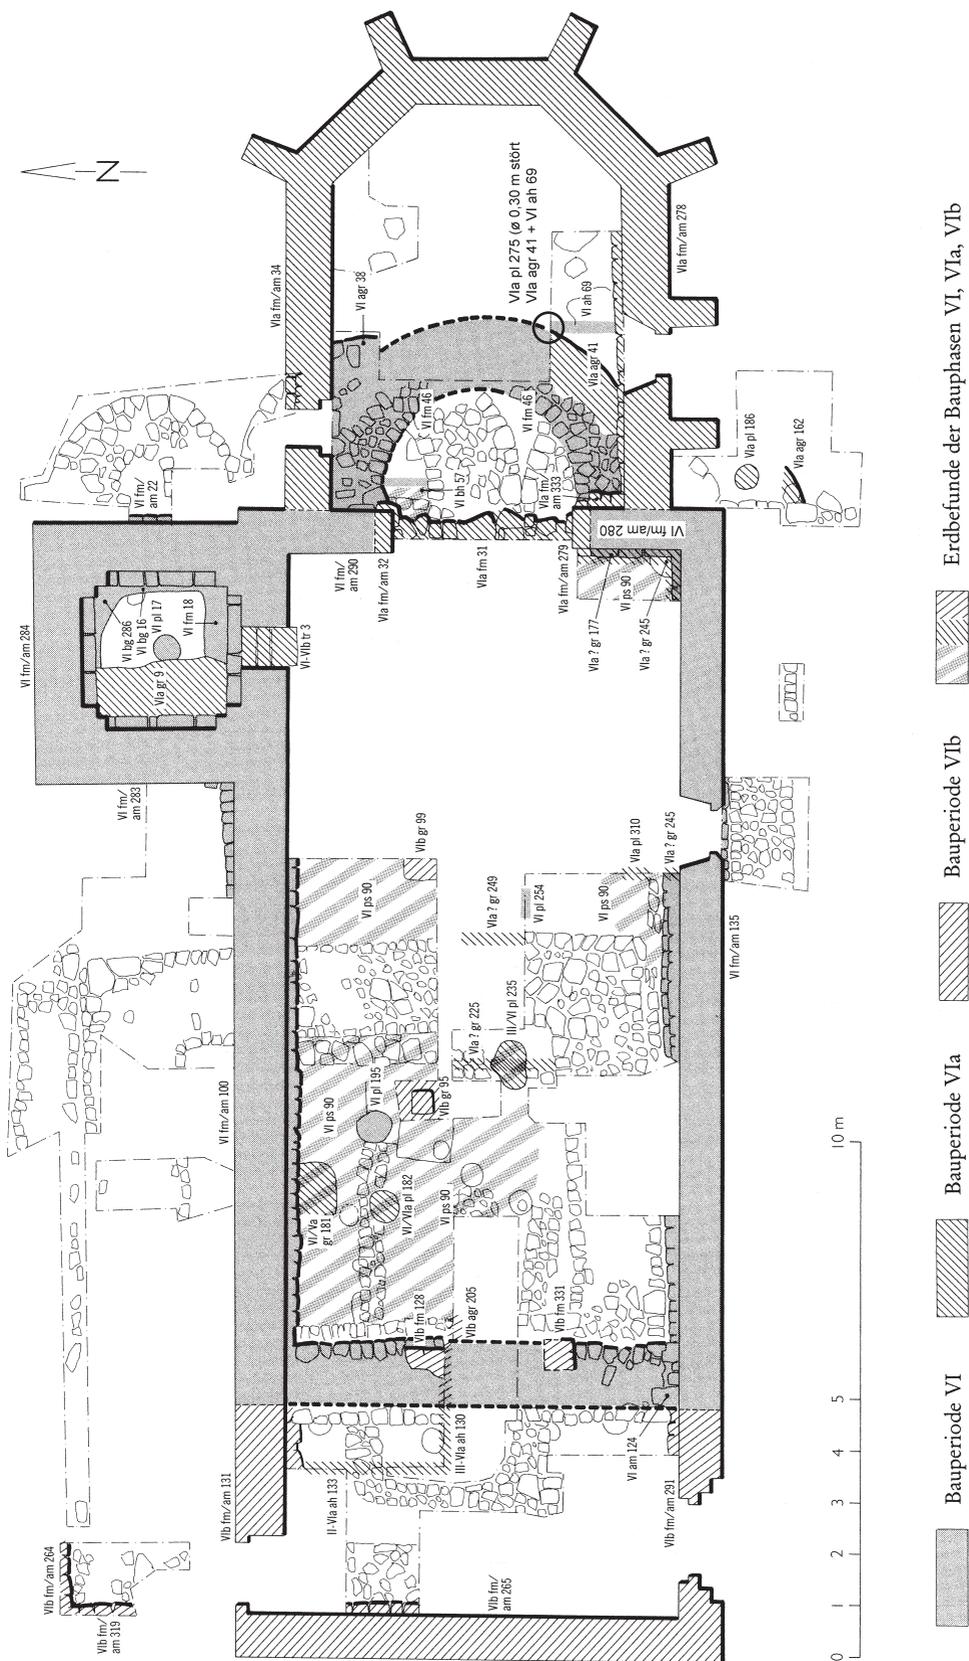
Starzach-Wachendorf, Kirche SS Peter & Paul. Grundrissplan Bauphasen VI–VIb (Zeichnung: Th. Schwarz, LDA Baden-Württemberg).
